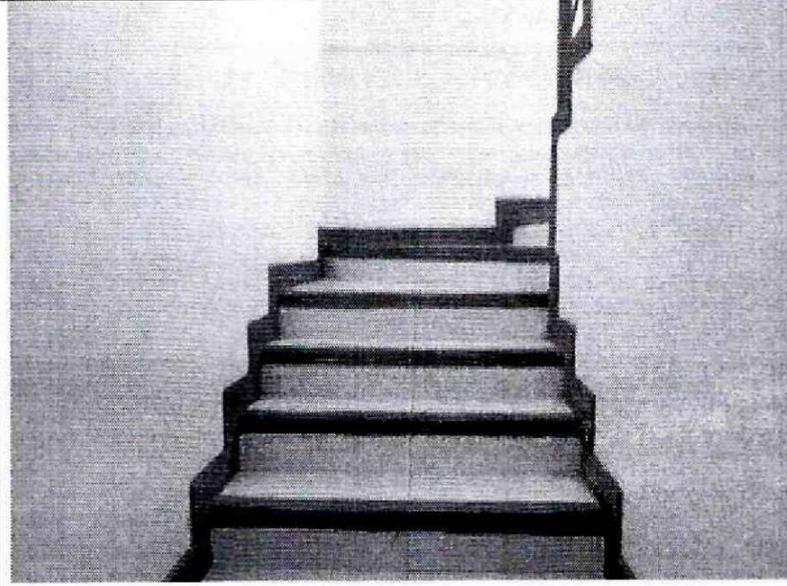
Escaleras a tercer piso sin evidencia de daños.
